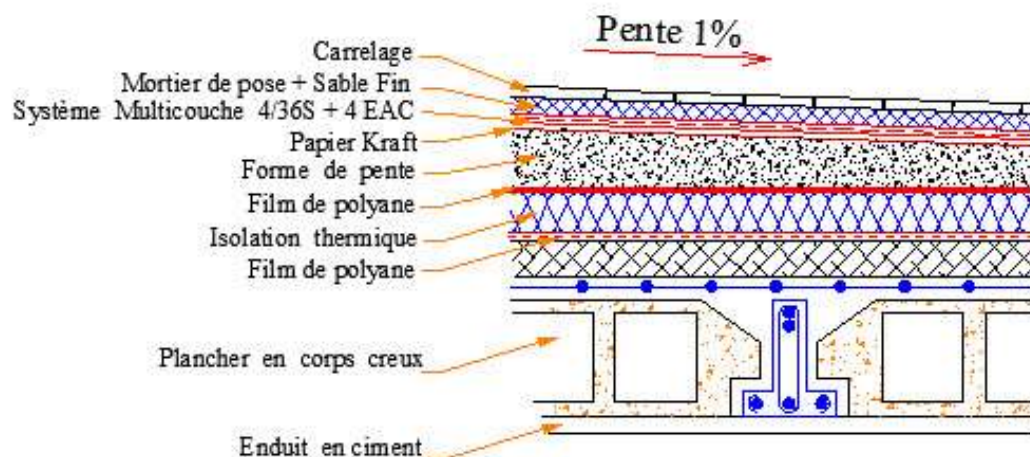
Coupe verticale du plancher terrasse accessible (corps creux)
